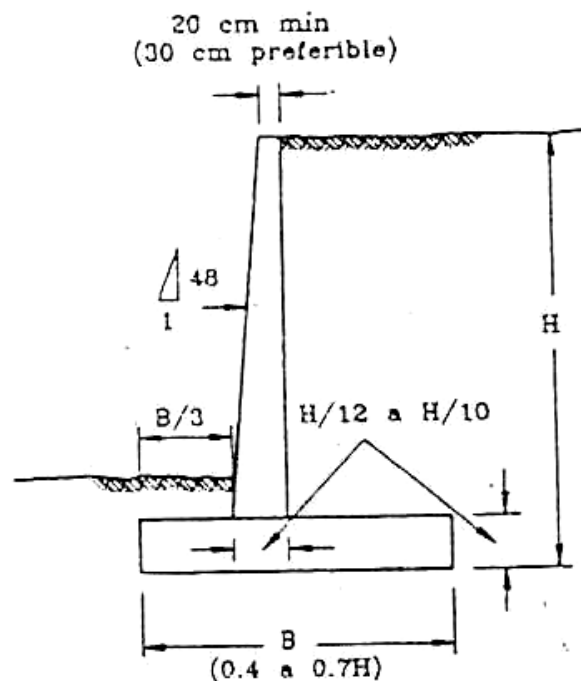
Predimensionamiento para un muro de concreto armado
